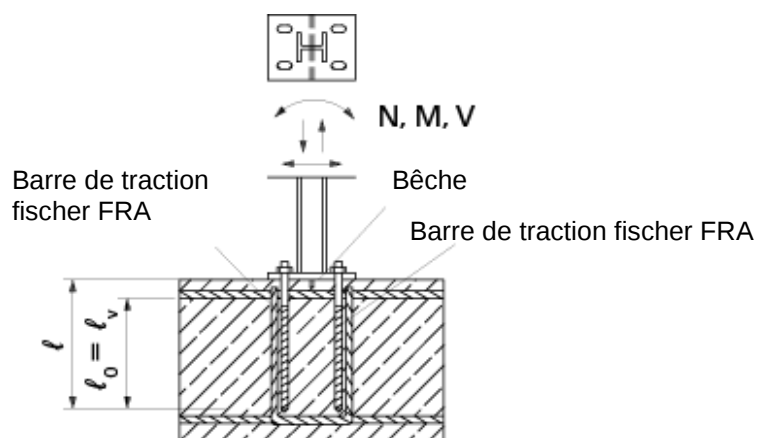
Recouvrement d'armature sur une fondation d'une colonne soumise à flexion.
